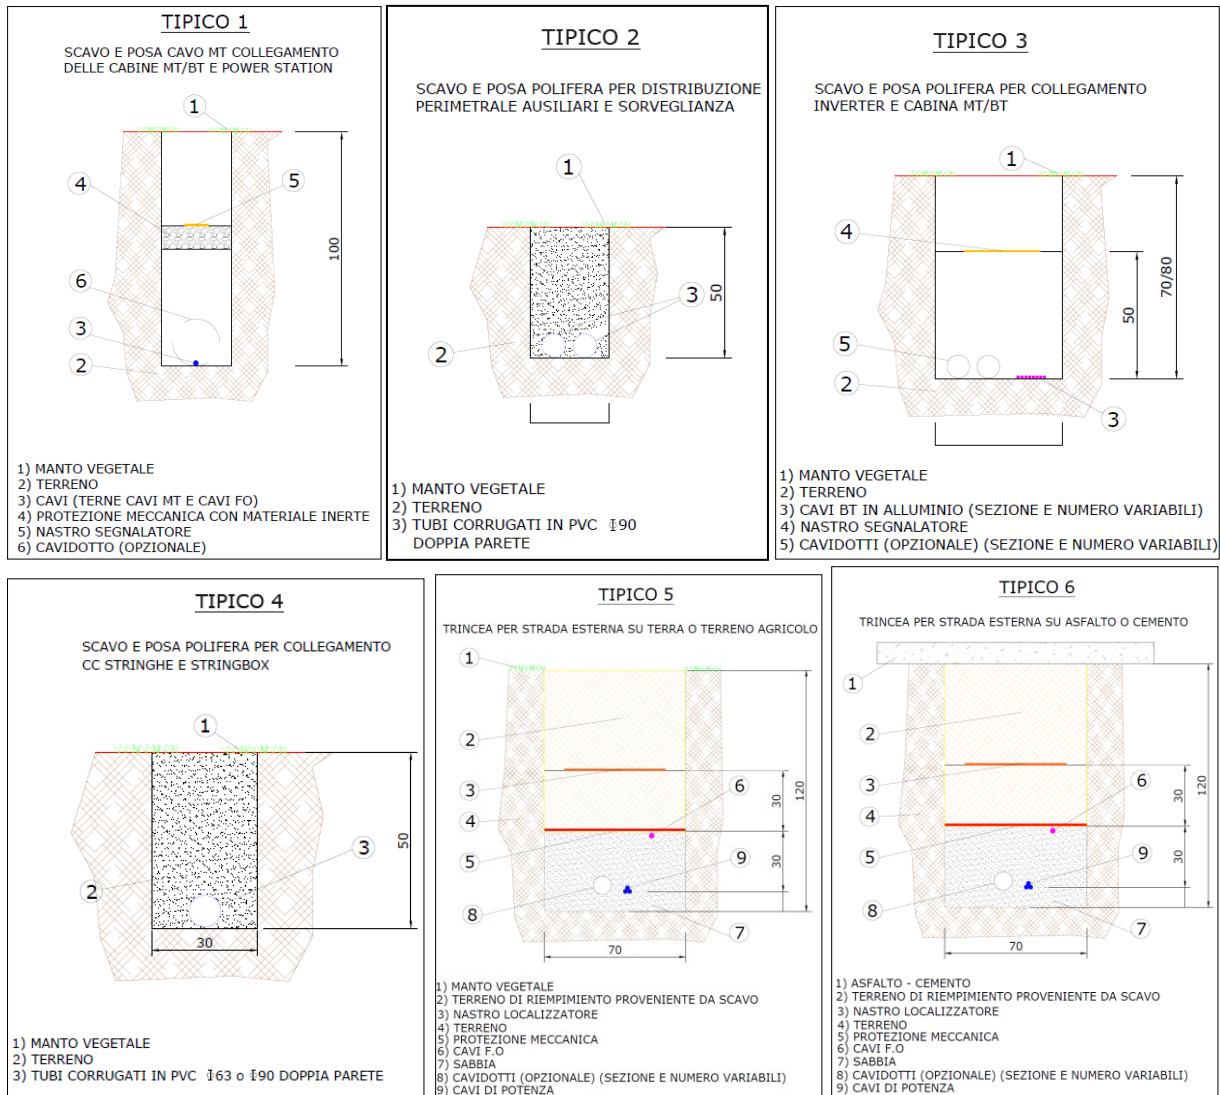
particolare dei cavi nelle aree dei parchi AV.
